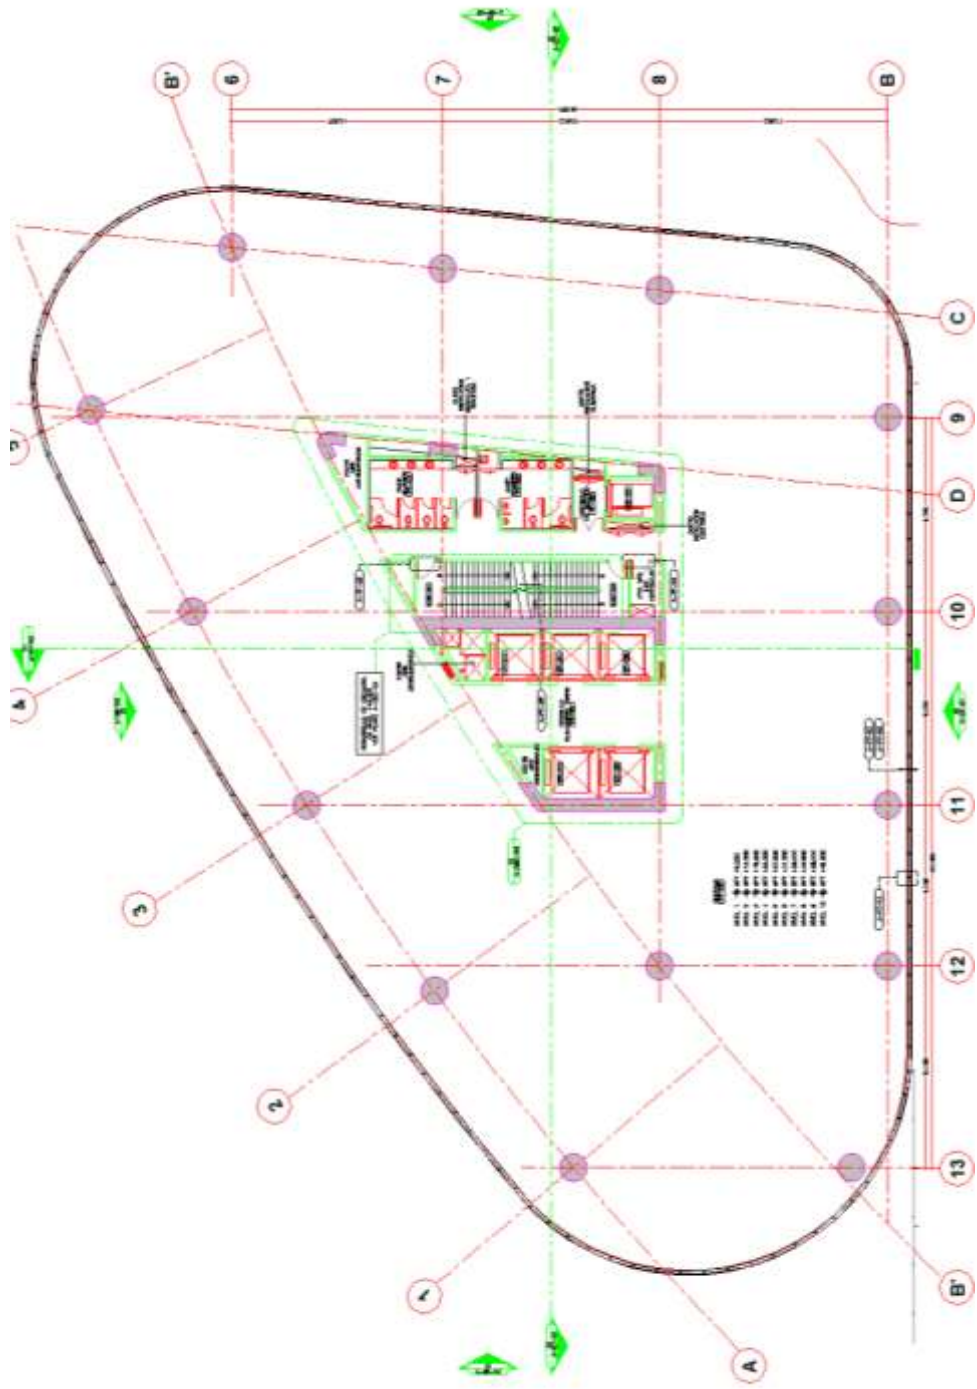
ANTEPROYECTO PLANTA ARQUITECTONICA PLANTA TIPO OFICINAS
